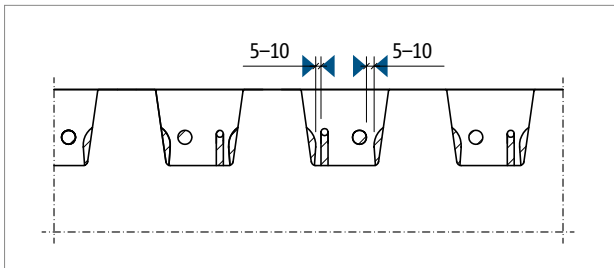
Schöck IDock®: Vloeruitsparingen, opgevuld met gietbeton Cuglaton® 4 mm (K70)
